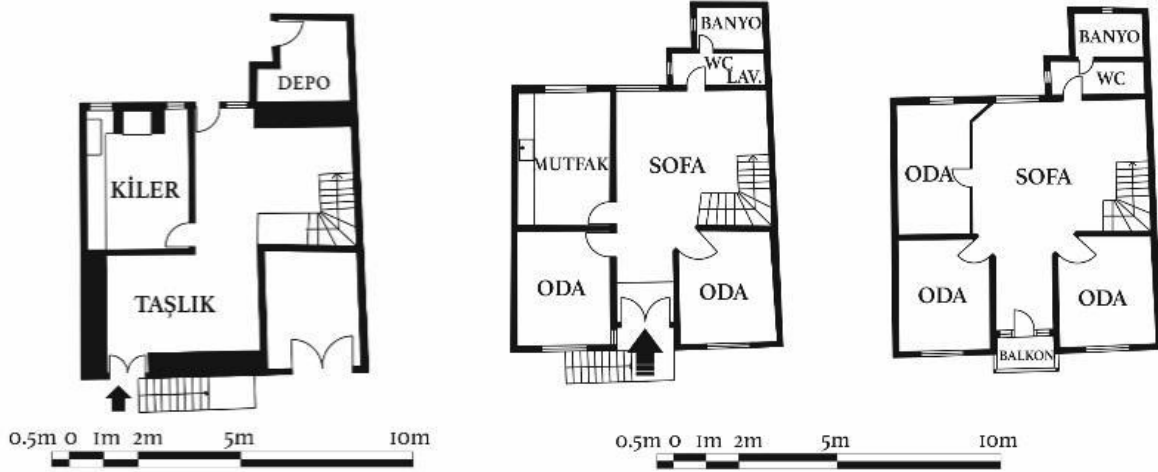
Bodrum kat planı (solda) (Nevnihal Erdoğan, 2018) Şekil 16. Zemin kat planı (ortada) (Nevnihal Erdoğan, 2018) Şekil 17. Birinci kat planı (sağda) (Nevnihal Erdoğan, 2018)
